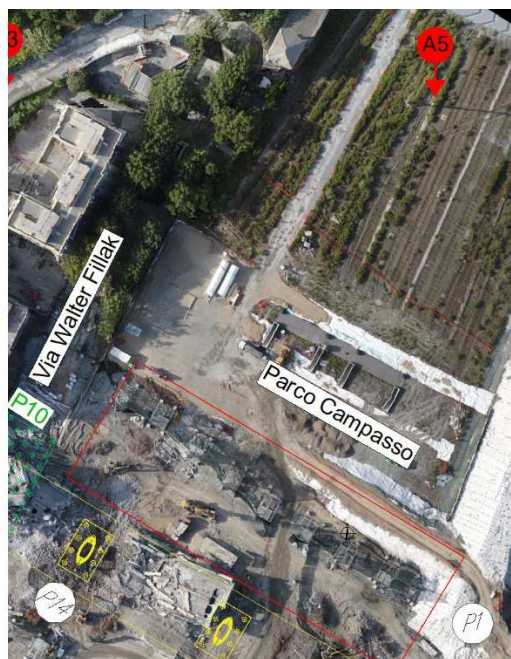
Postazione levante a Nord (44.425934 N, 8.890475 E) – PPN3 – A5
